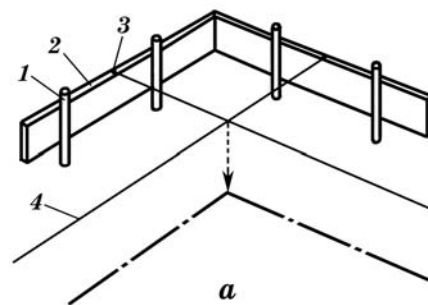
Подготовка площадки к строительству фундамента: а – разбивка фундамента: 1 – стойка обноски; 2 – доски; 3 – гвозди; 4 – ось фундамента (провока).
